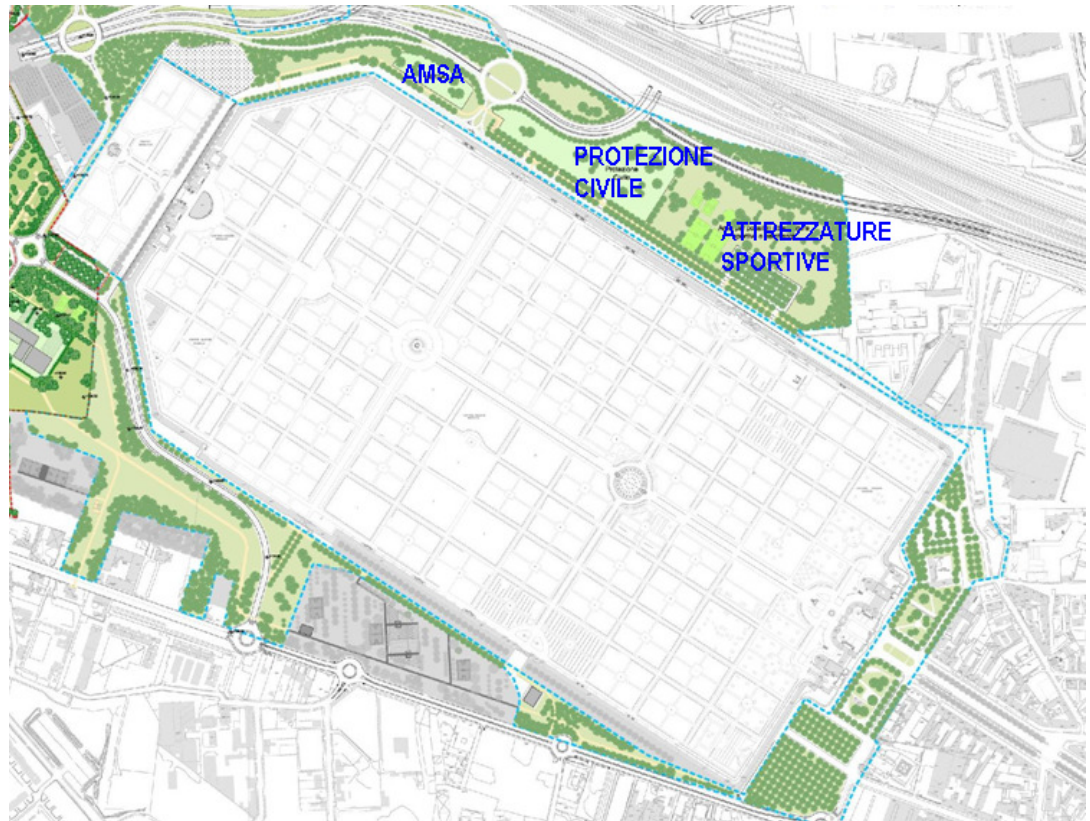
planimetria sistemazione aree tra il Cimitero e via Triboniano - via Barzaghi
